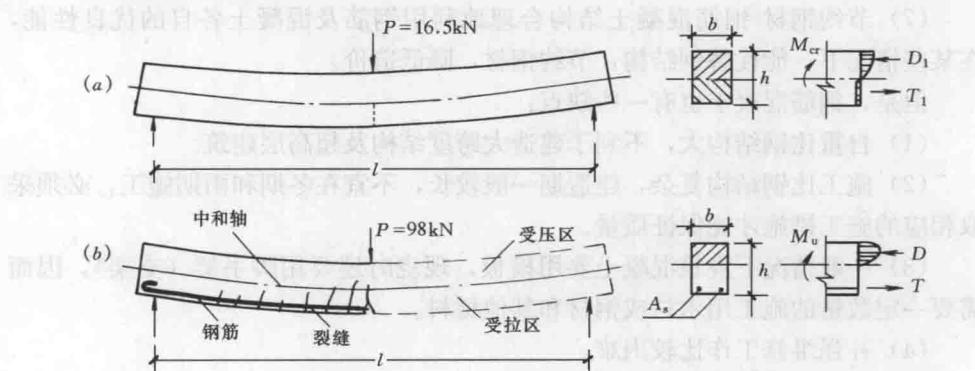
混凝土及钢筋混凝土简支梁的承载力
